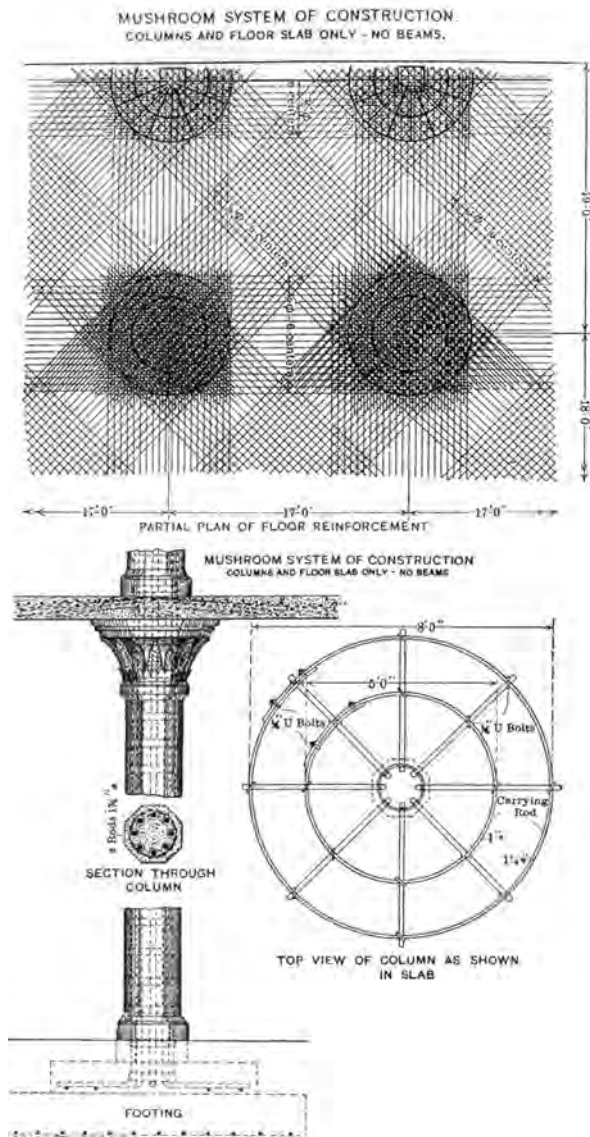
C.A.P Turner: sistema de laje plana "cogumelo", 1905. Detalhe da armação do plano da laje em 4 sentidos. [GASPARINI, 2002]:1246
